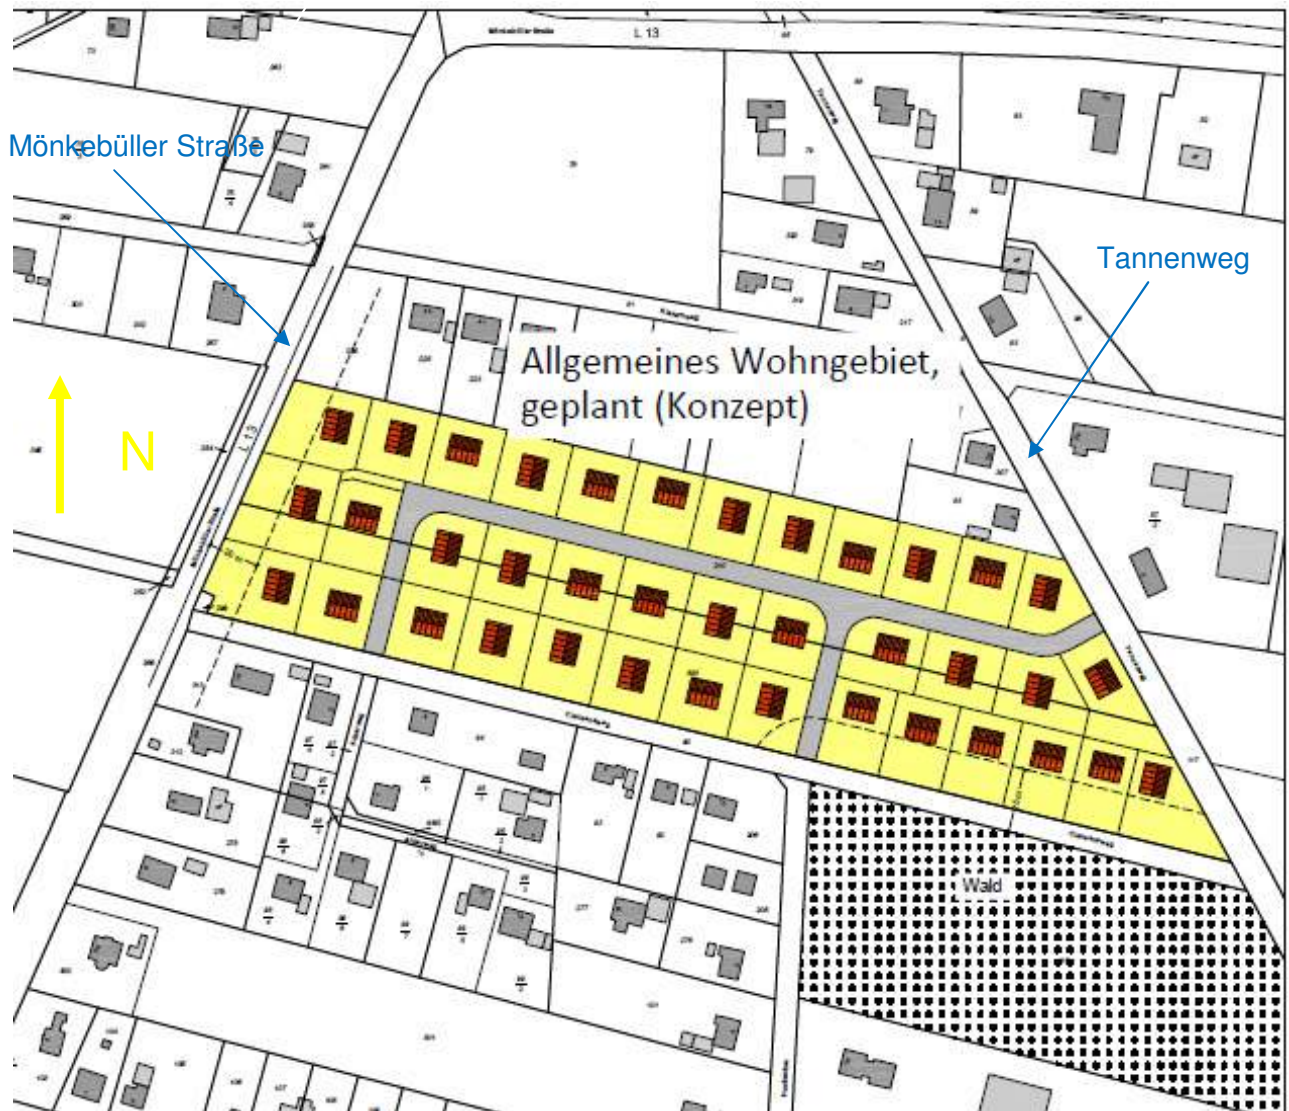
Plangebiet B-Plan Nr. 23 in Langenhorn Mönkebüll
